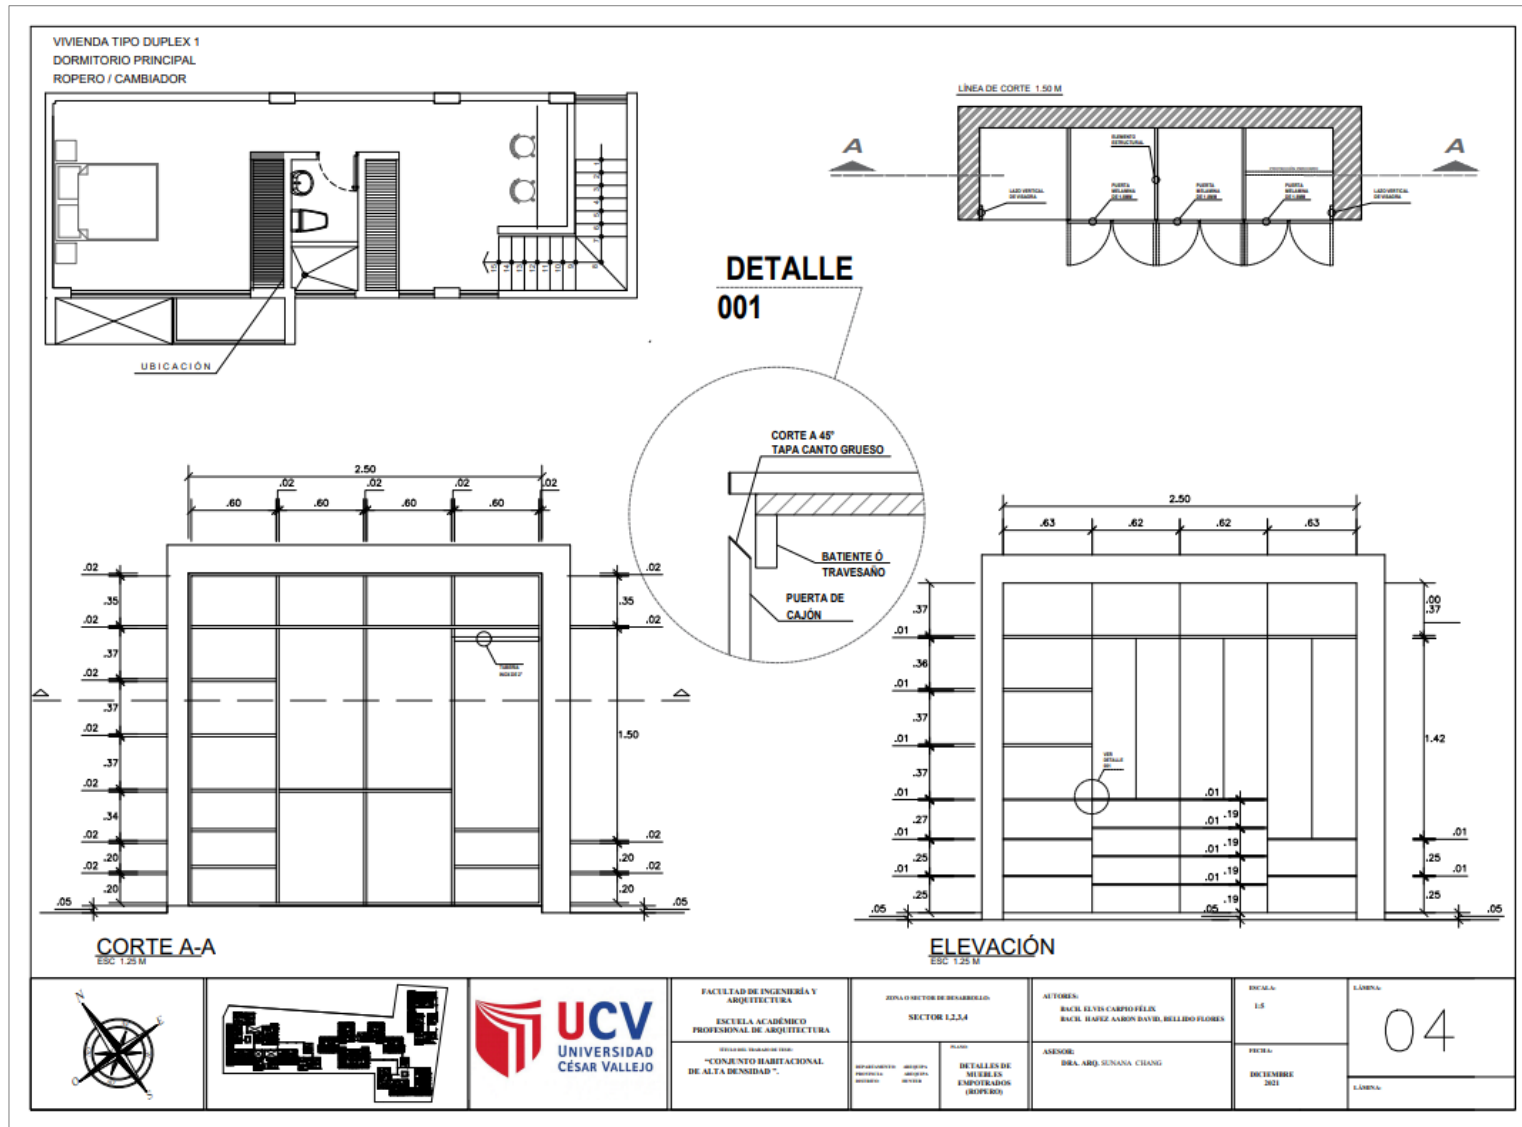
Plano de Detalle Arquitectónico – Armarios Vivienda Tipo Dúplex 1 - 04
